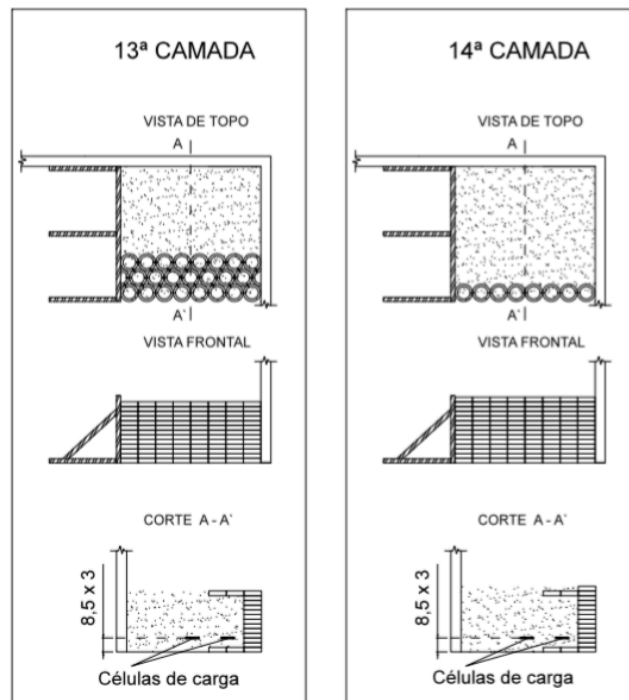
Faseamento construtivo da 13ª à 14ª camada.
